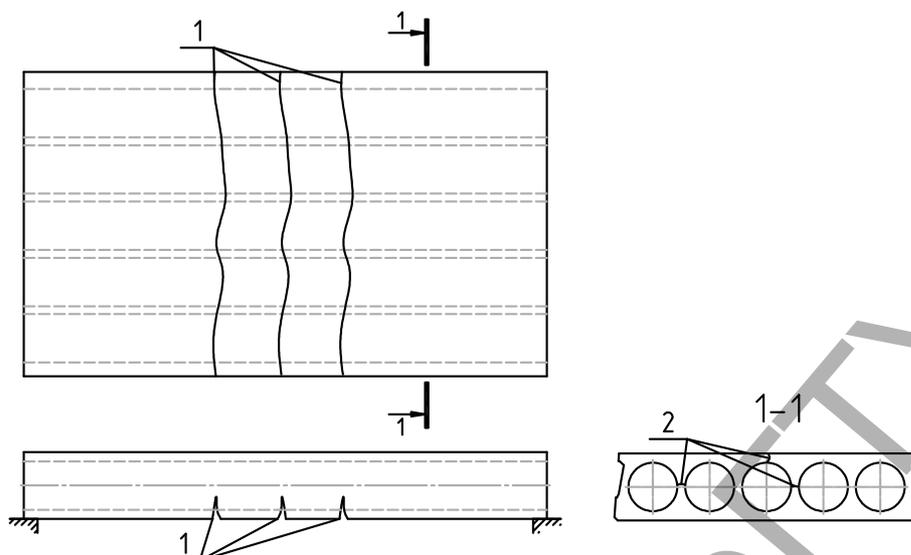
Силловые и технологические трещины в пустотной панели перекрытия [4]:
